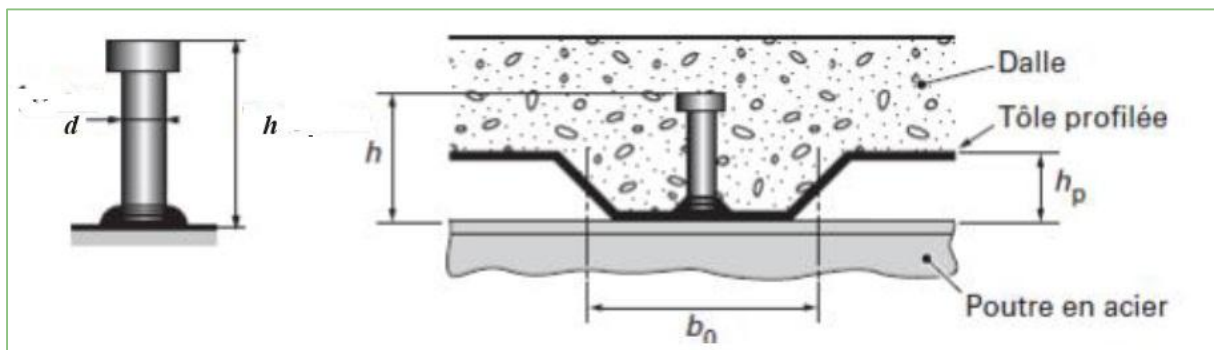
Goujon à tête soudée avec dalle mixte.
